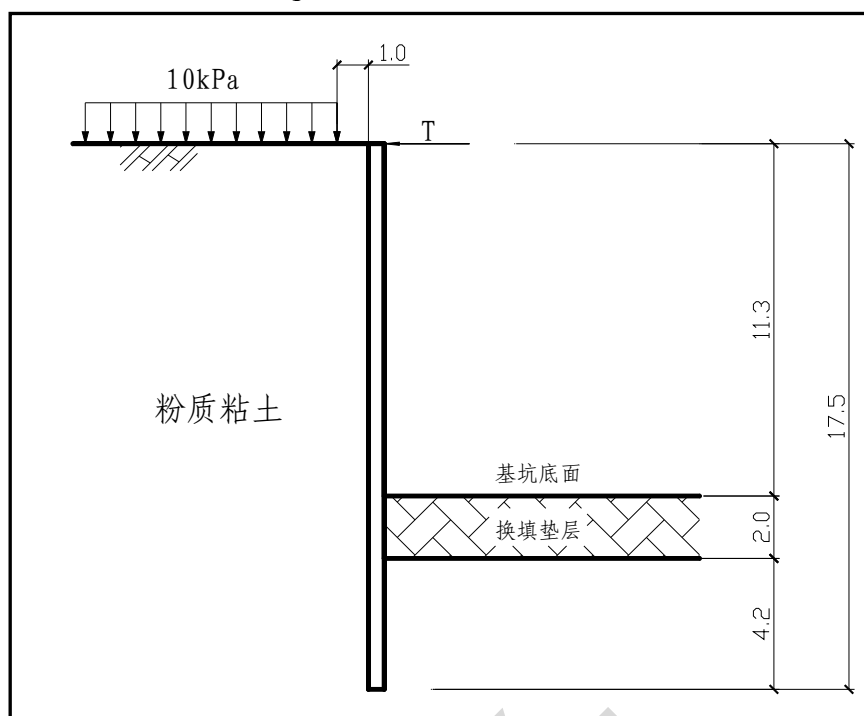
3# 桩处原设计基坑示意图 (尺寸单位: m)
